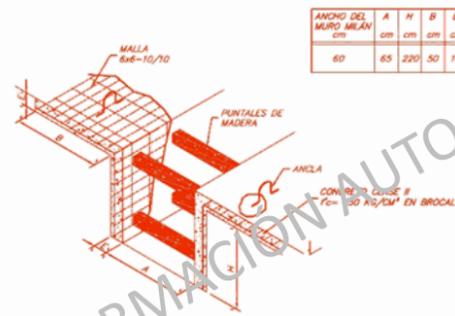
DETALLES DE BROCAL DE CONCRETO REFORZADO
